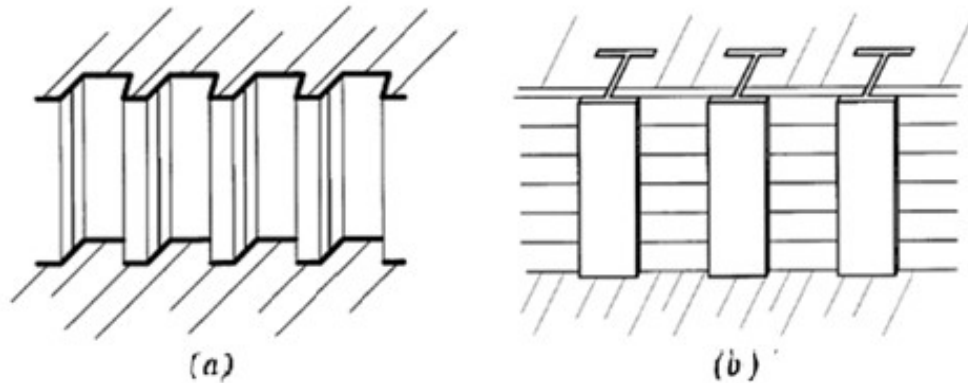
Estacas metálicas: a) Estaca Prancha; b) perfil metálico com pranchamento, adaptado de Ou, 2006
